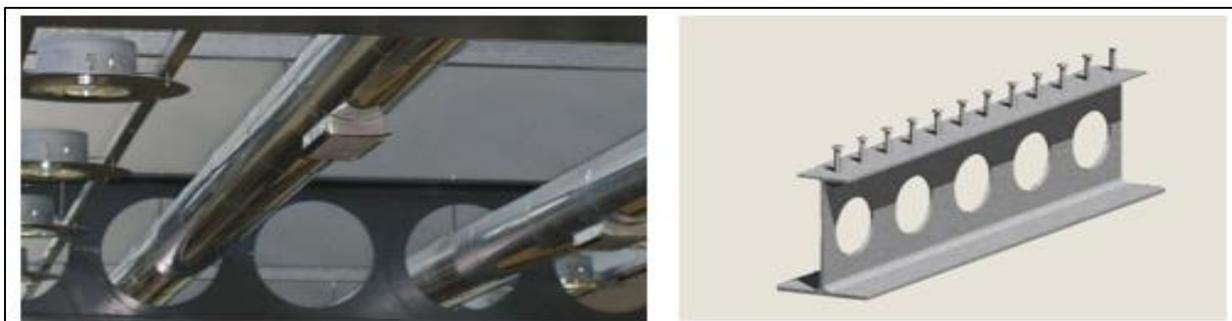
la poutre alvéolaire, (source : ArcelorMittal ,1996)
